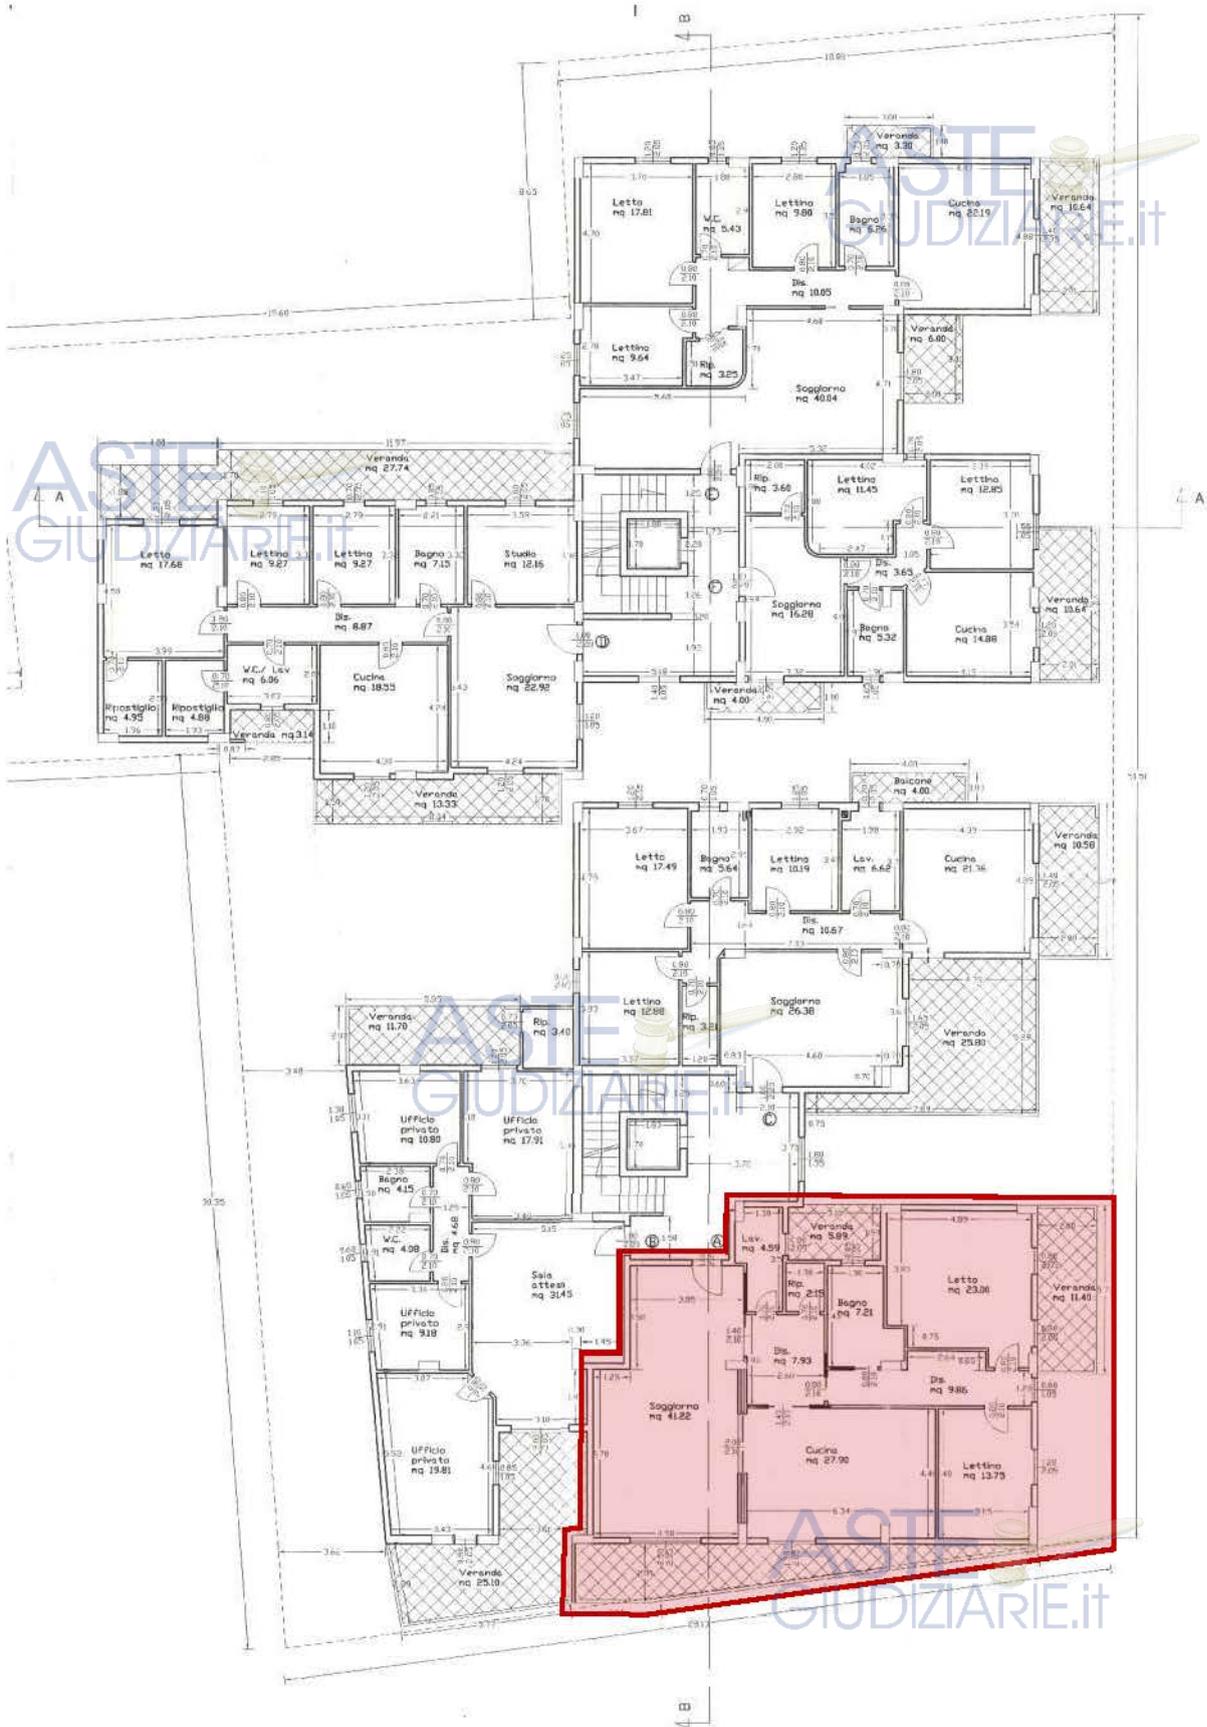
Tav. 04 – Pianta Piano Primo (Conc. Edil. 73/2011) con indicazione del Sub 63
